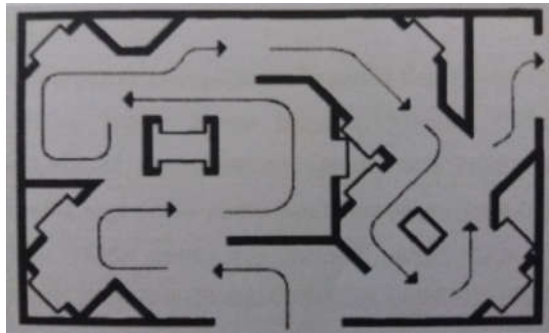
Denah Pendekatan Alur Yang Tidak Terstruktur
